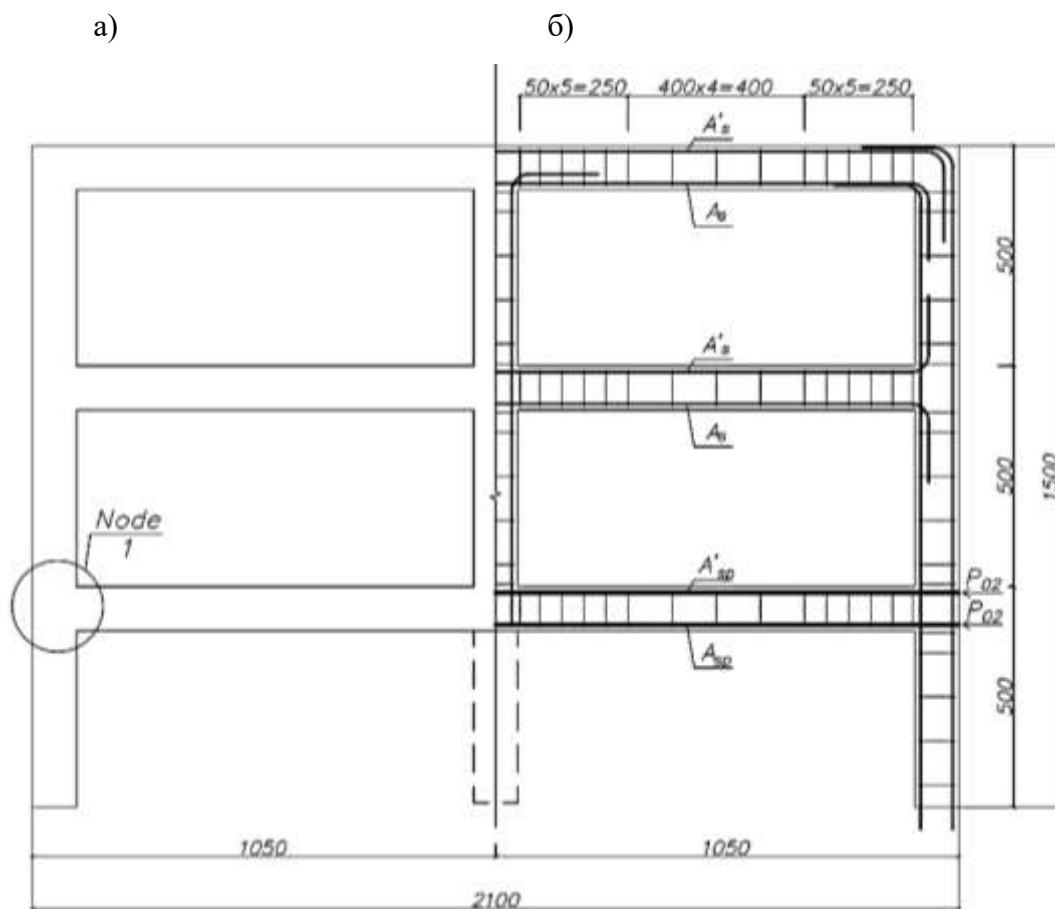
Схема конструкции опытной рамы с предварительно напряженными ригелями: опалубка (а), схема армирования (б)
